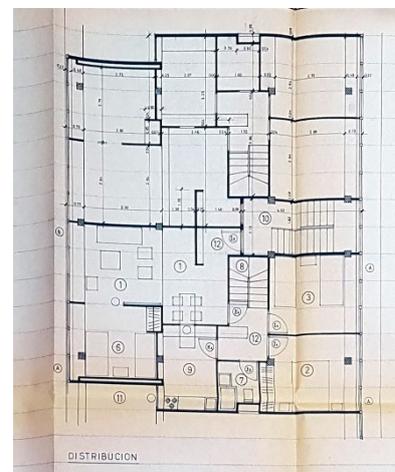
Planta primera dúplex Distribución B-3-5. 1964. Fuente: Archivo Municipal da Coruña
